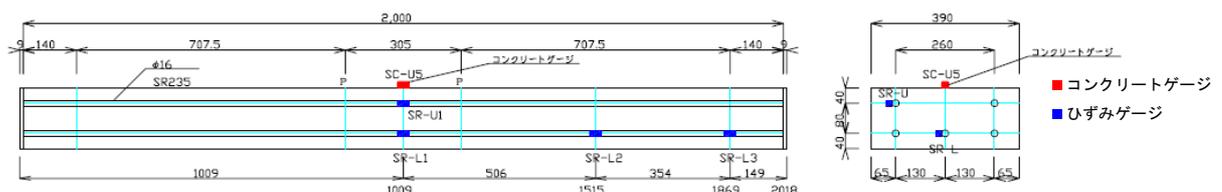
RC はり供試体の形状寸法および配筋状況 (丸鋼の例)
